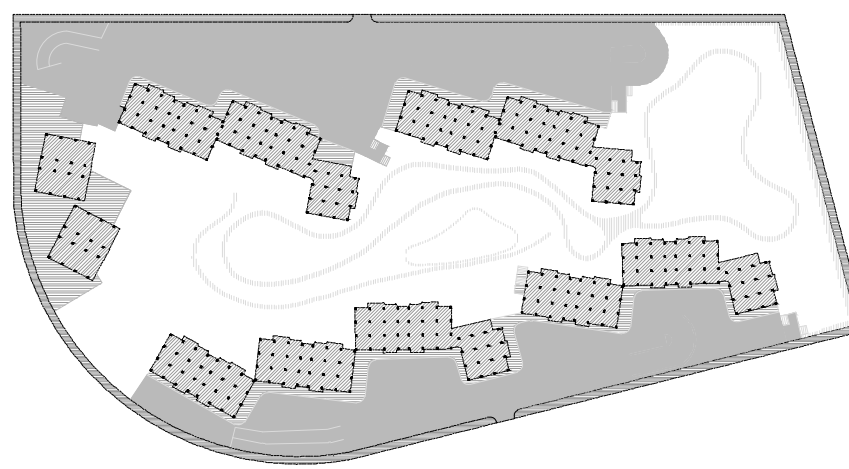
Esquema en planta de pavimentos. E. 1:2000
